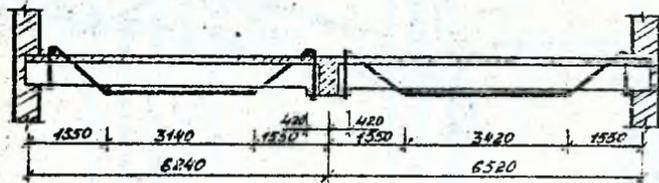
Схема усиления второстепенных балок перекрытия варочного отделения ГЛБЗ
